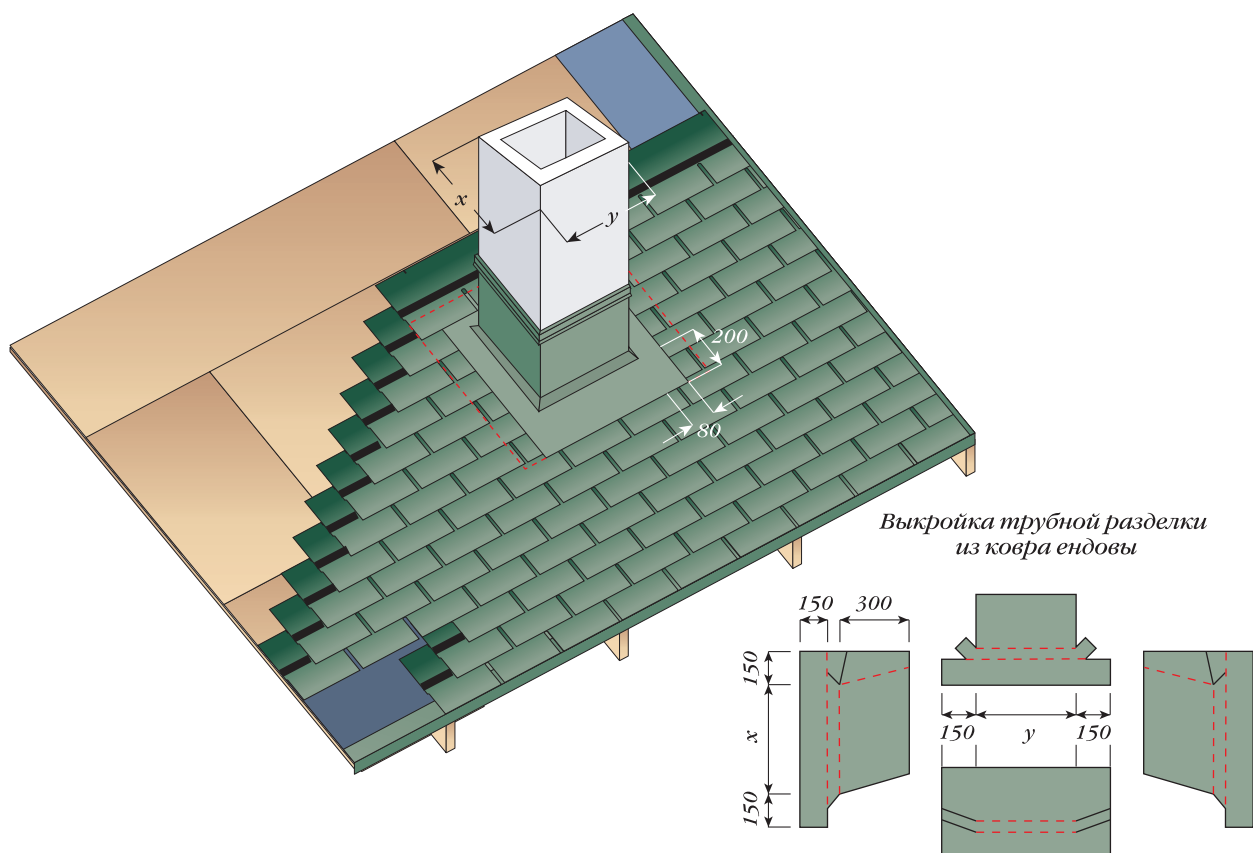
Примыкания кровли к трубе (размеры в мм)
